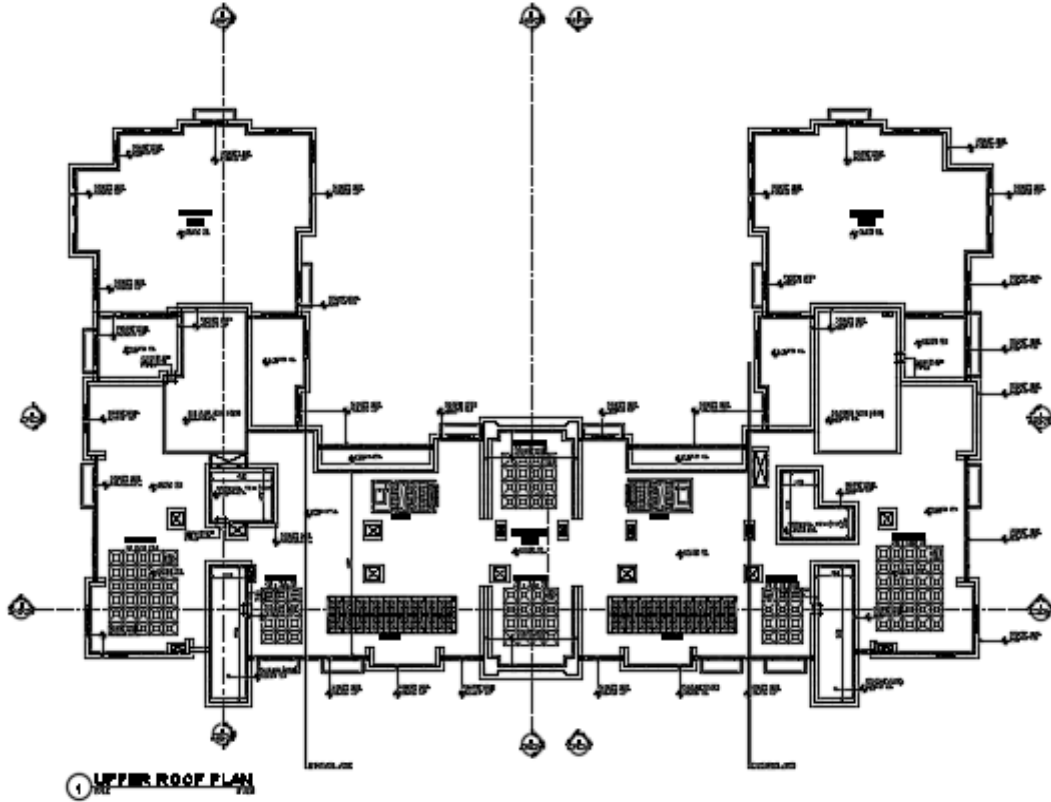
المسقط الأفقي للطابق الخامس (الروف الأول)
